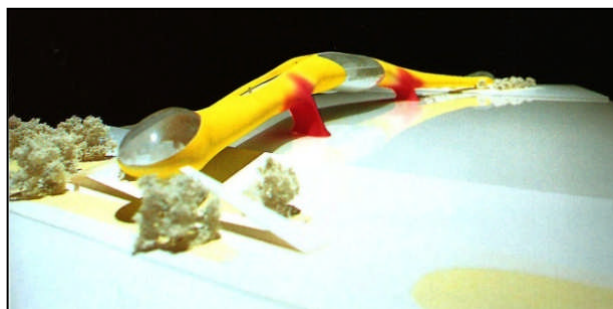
, Future Systems, *The People's Bridge*, 1996. Maquete.
